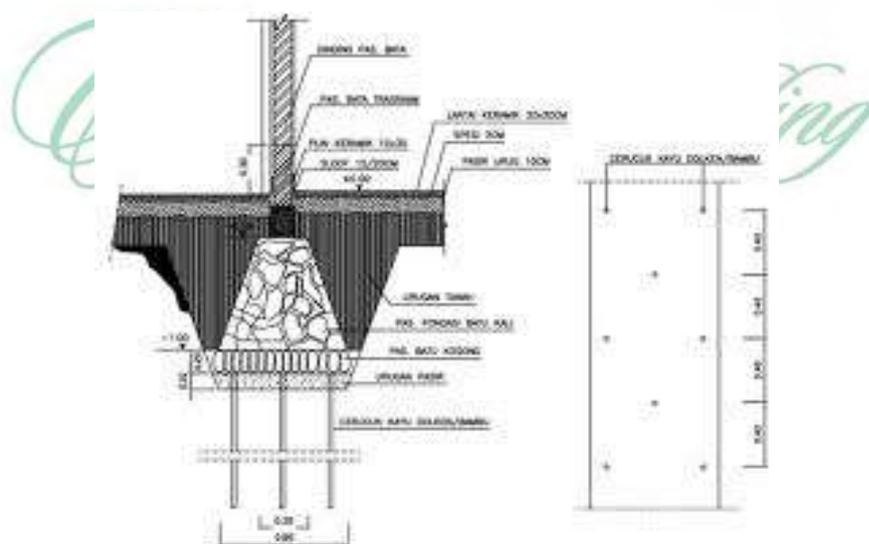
menunjukkan gambar detail pondasi yang terbuat dari batu kali. Pada gambar tersebut terlihat bagian-bagian dari suatu pondasi, mulai dari pasir urug, astamping (batu kosong), pondasi batu kali, tanah urug, sloff, pasir urug dibawah lantai, lantai, pasangan trasram (kedap air), dan pasangan batu bata. Setiap bagian dari suatu pondasi mempunyai fungsi.
